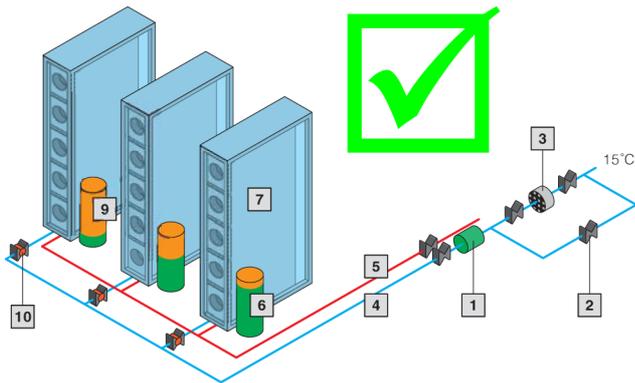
Kälteverteilung mit hydraulischem Abgleich
